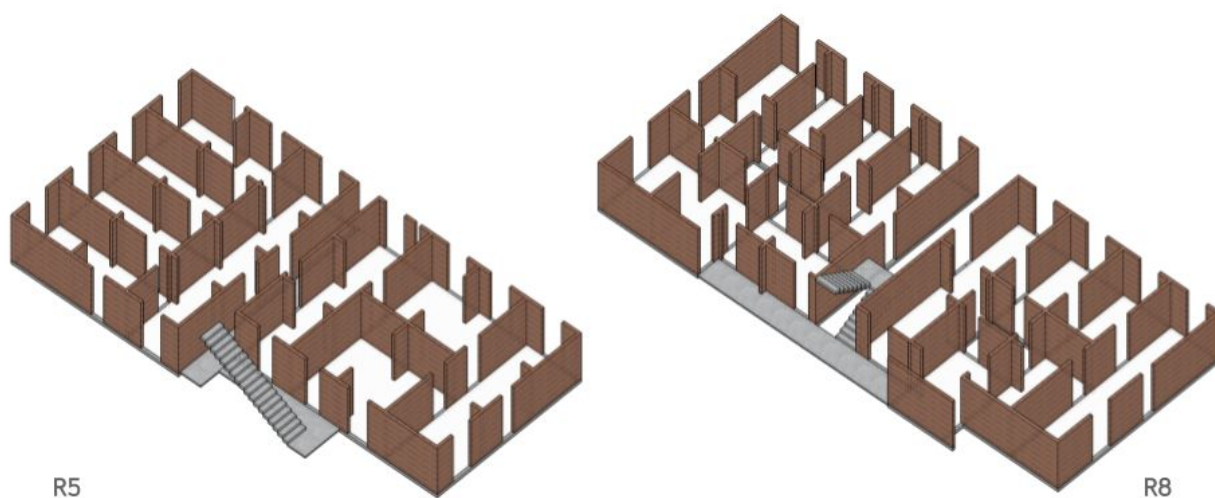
Vista Isométrica do Grid Estrutural do Pavimento Tipo
